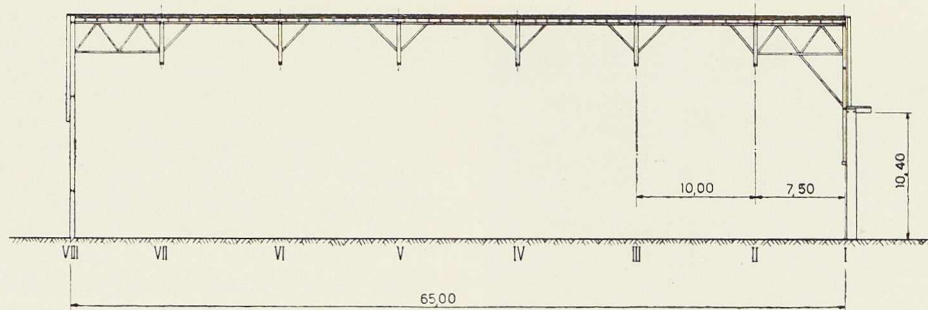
Coupe longitudinale du hangar d'aviation.
